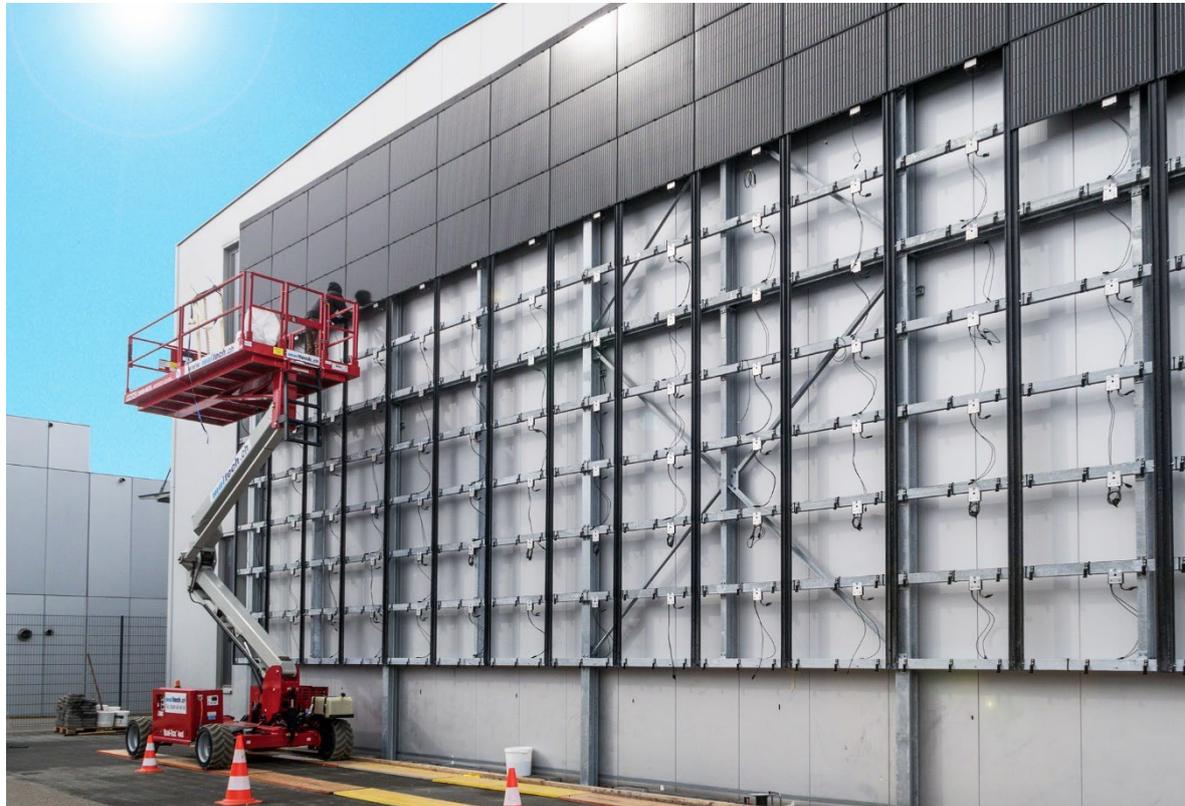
TeraSlate Fassade mit Alu-Modullattung und Profilstahl-Unterkonstruktion
